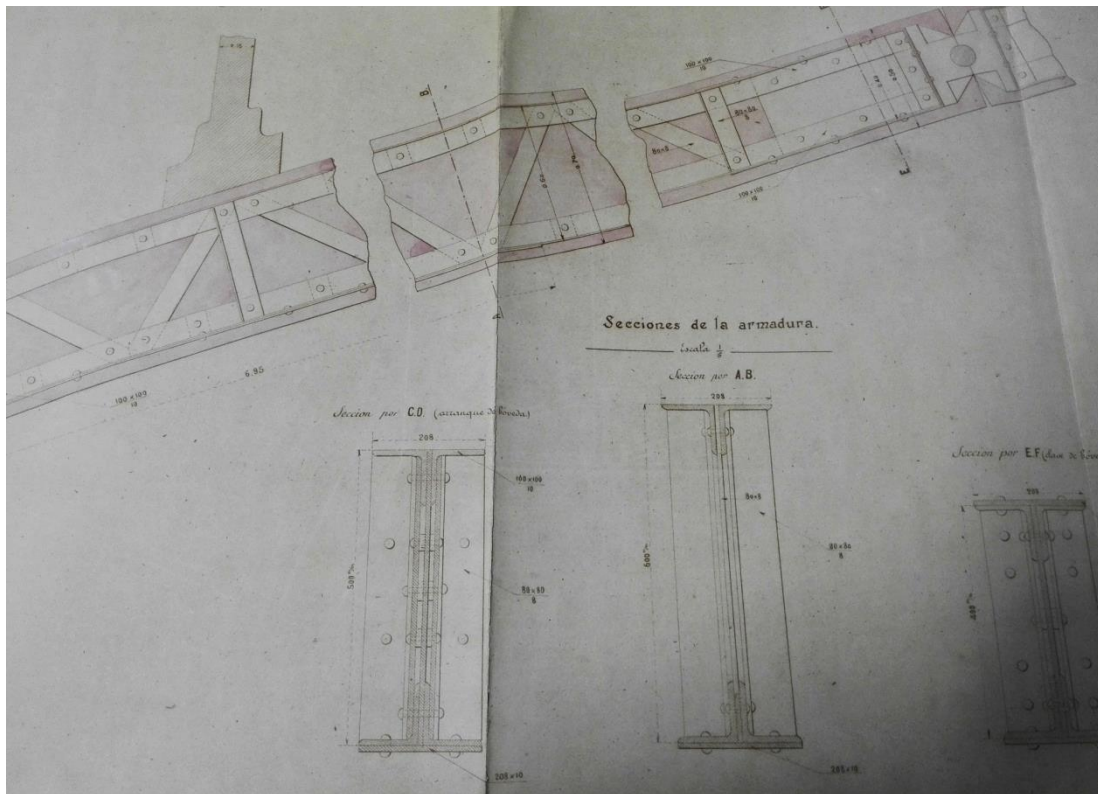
Detalle de la armadura de las bóvedas del Puente sobre el río Caudal. 1902 Archivo Demarcación de Carreteras del Estado
